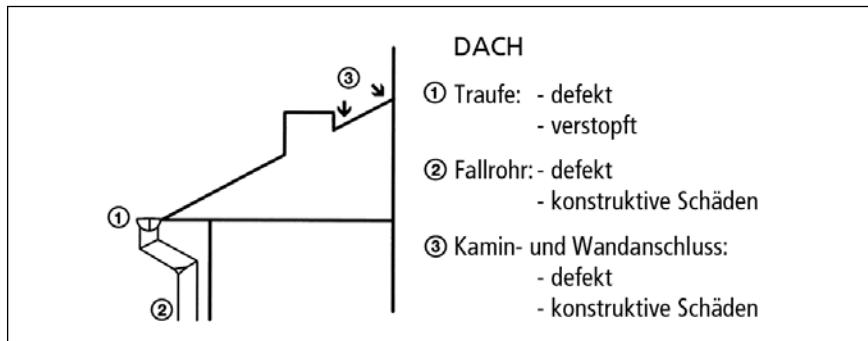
■ Mögliche Schadensquellen an Dachrändern und -anschlüssen
